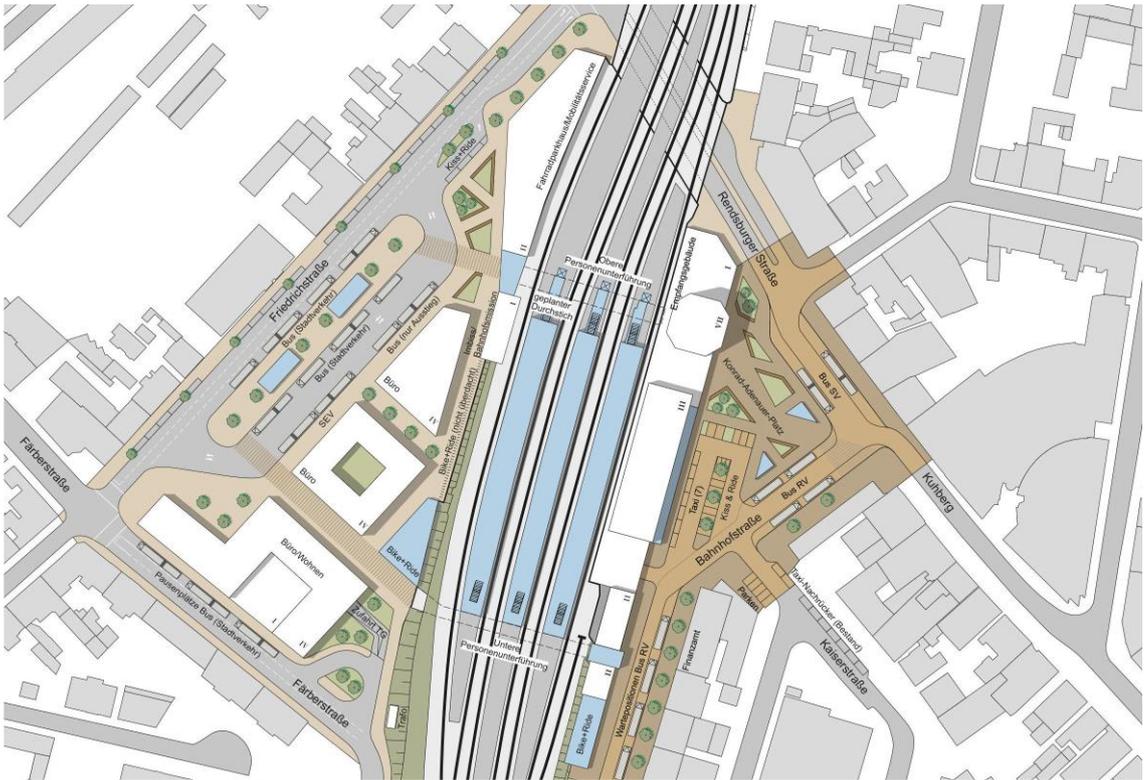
Ausschnitt des Lageplans II B – Ersatz Postgebäude / Bebauung Parkplatz
